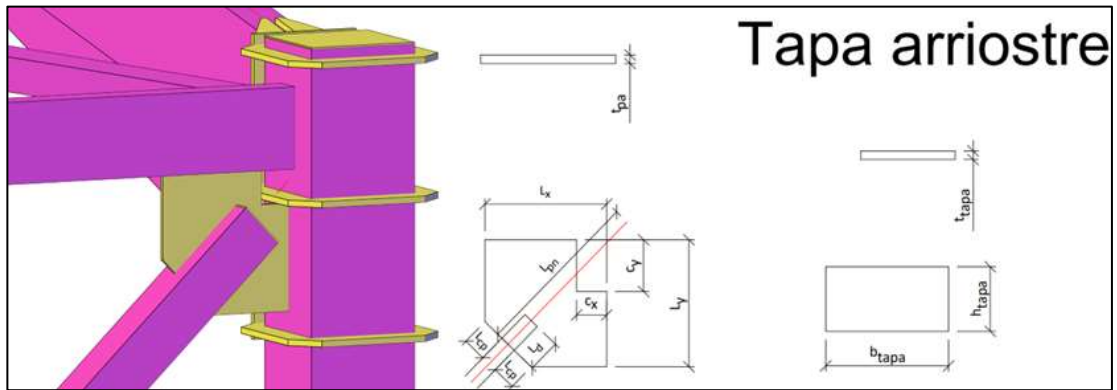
Conexión a corte Arriostre – Columna (Perfiles: tubulares)
